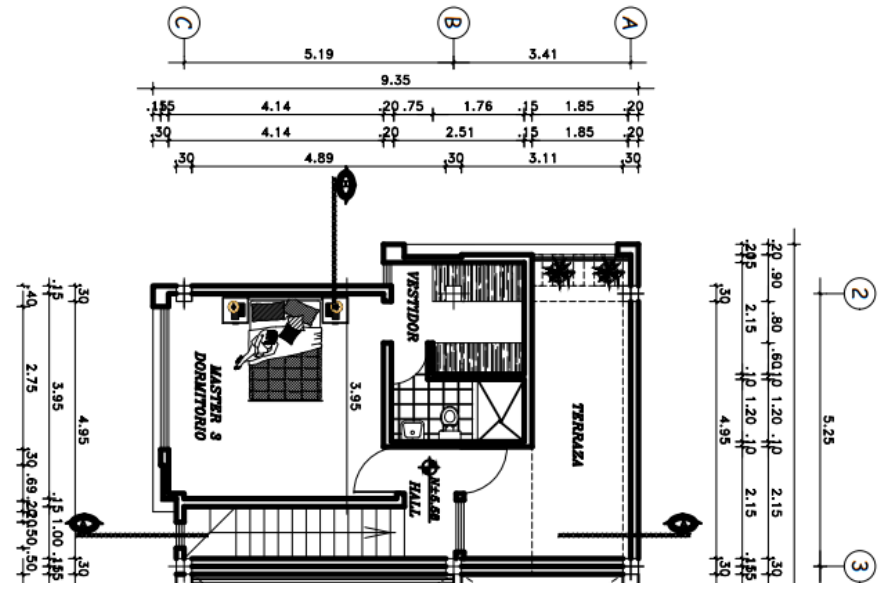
Plano Arquitectónico Planta Alta 1 Casa Tipo
